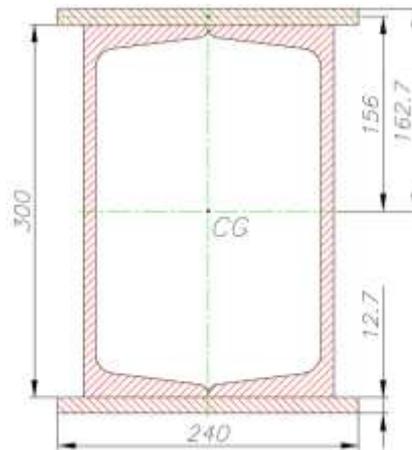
Sección transversal viga puente manufacturado. Fuente: (Autor)
